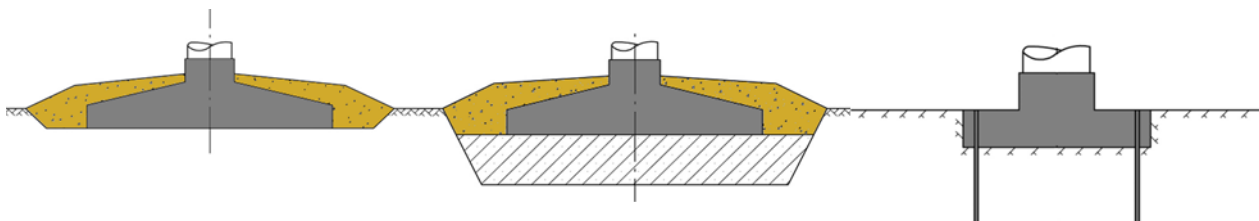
Vindkraftverken kan grundas på många olika sätt. Principbilder av betongfundament,, stålbetongfundament med massabyte samt stålbetongfundament som har förankrats i berget.
